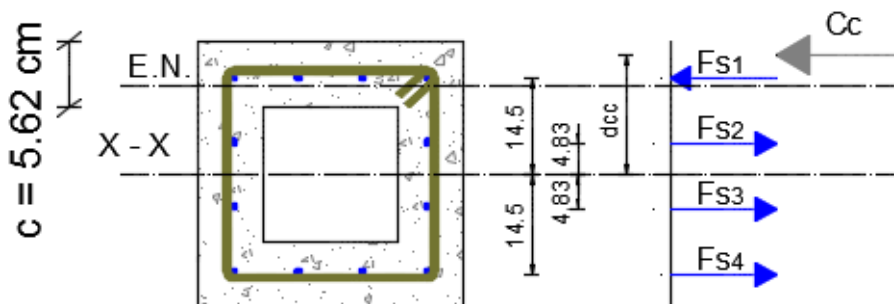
Esquema de esfuerzos y fuerzas en la sección transversal cuadrada
